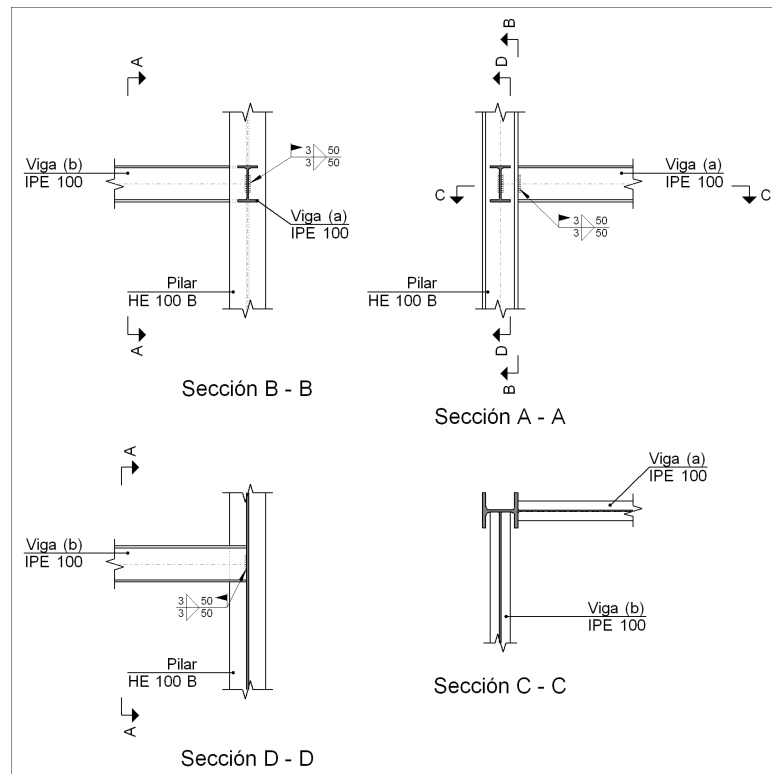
Detalle de las soldaduras tipo 2 de la estructura inferior de las escaleras
